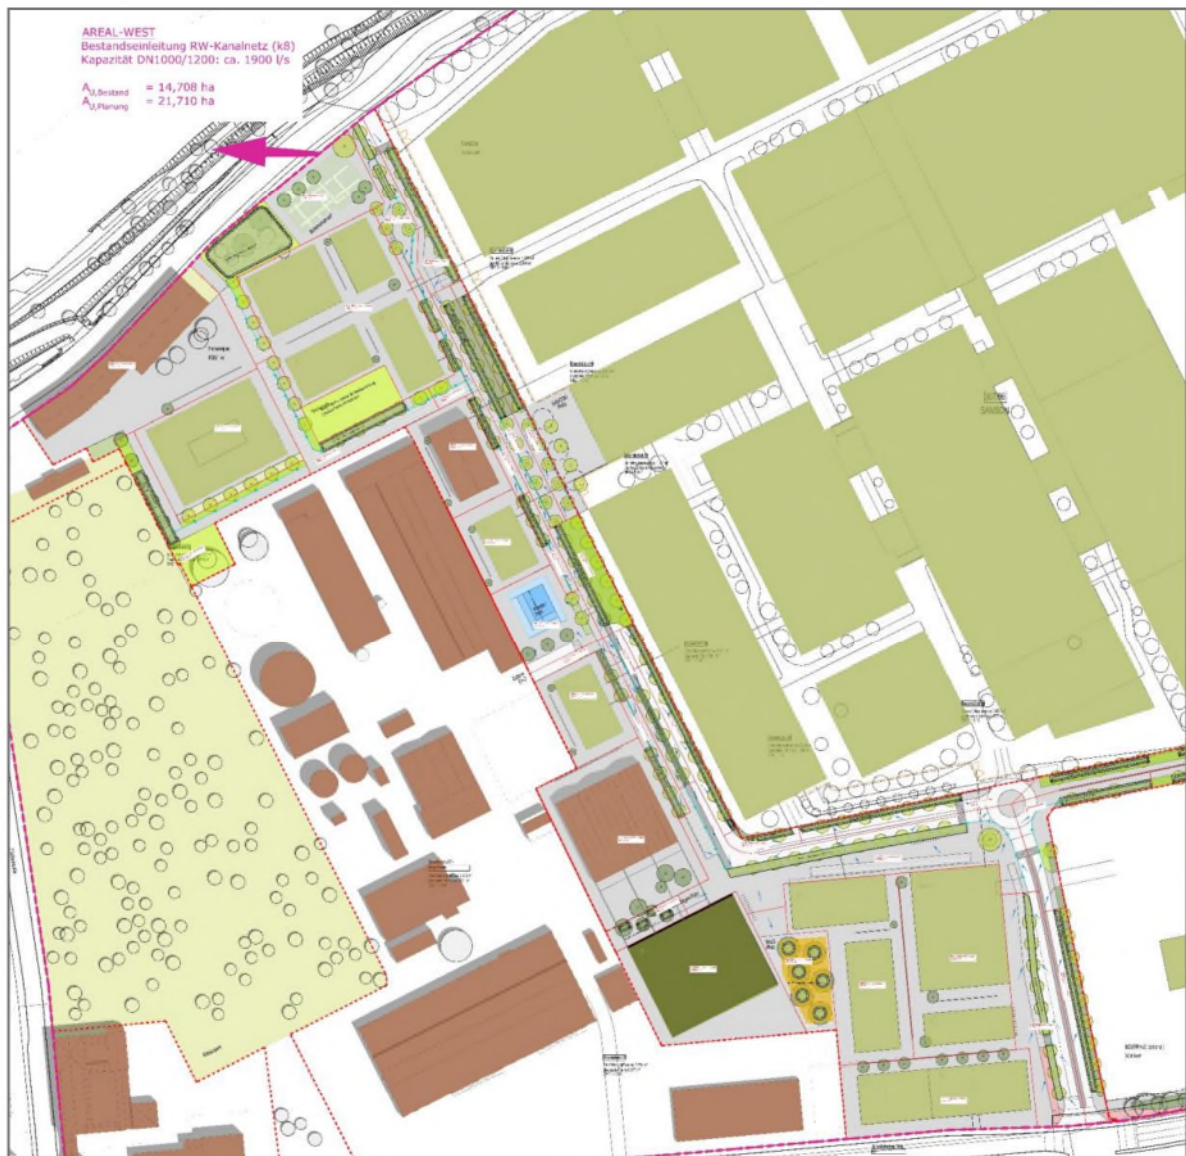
Lageplan Regenwasserkonzept mit Haltungsflächen (siehe Anhang E)
